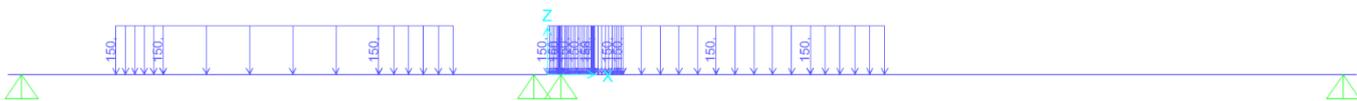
disposizione di carico 5 - SW/2 – pila 3
